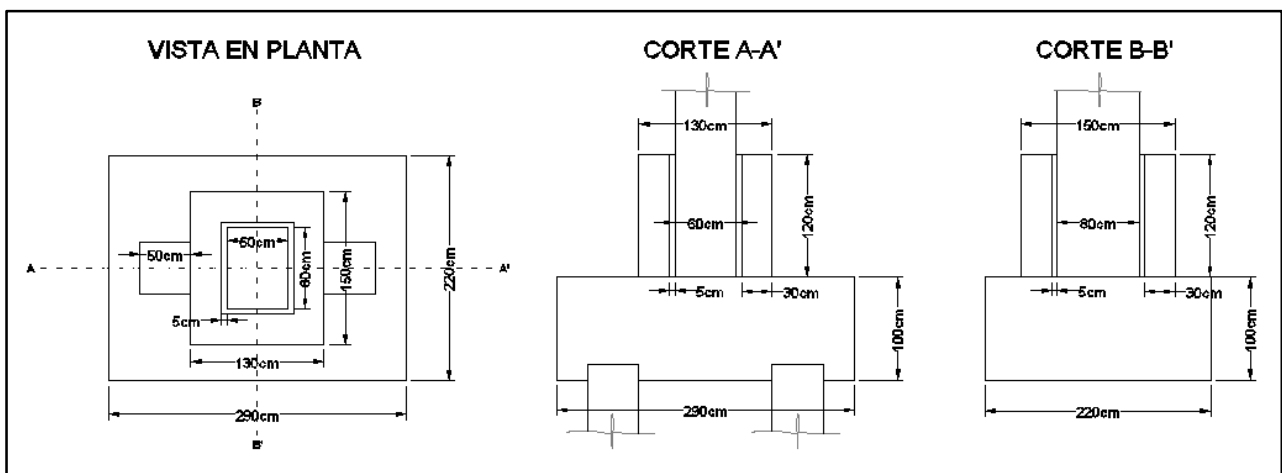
Vista en planta y frontal del dimensionamiento de la zapata. Fuente del autor.
